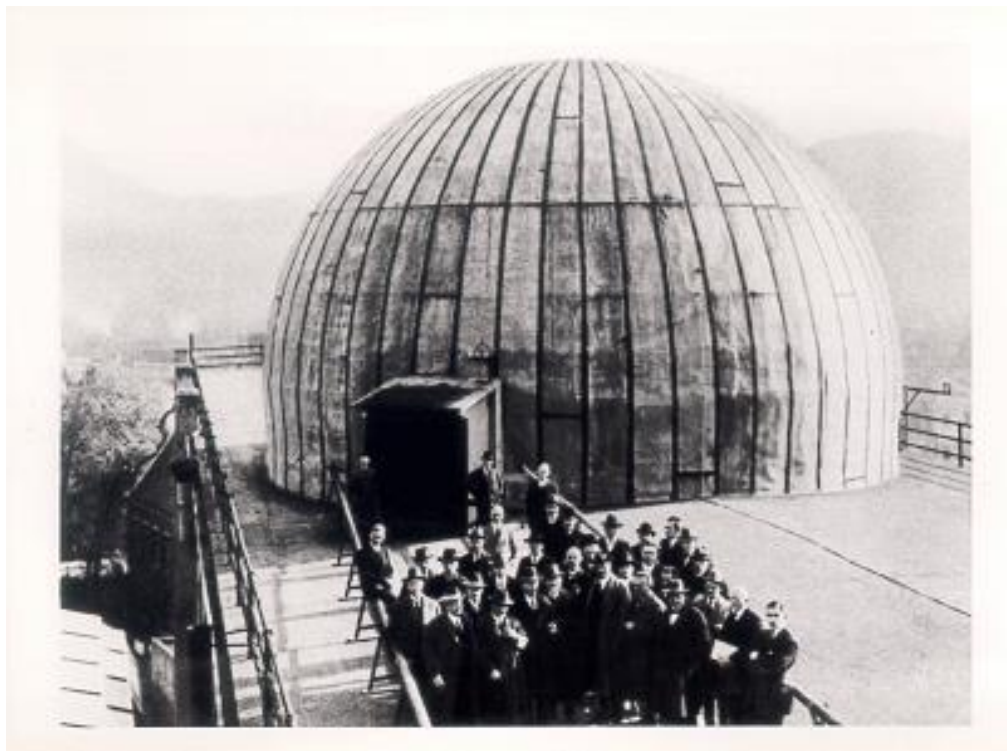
A cúpula de Jena com a vedação em argamassa armada, Alemanha 1992.
